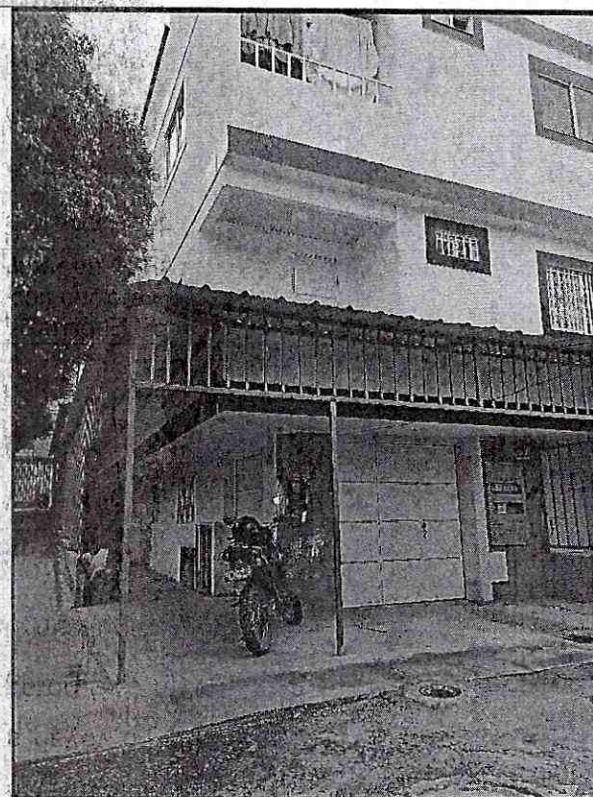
Fachada del inmueble en la calle 104 con carrera 7ª esquina.
